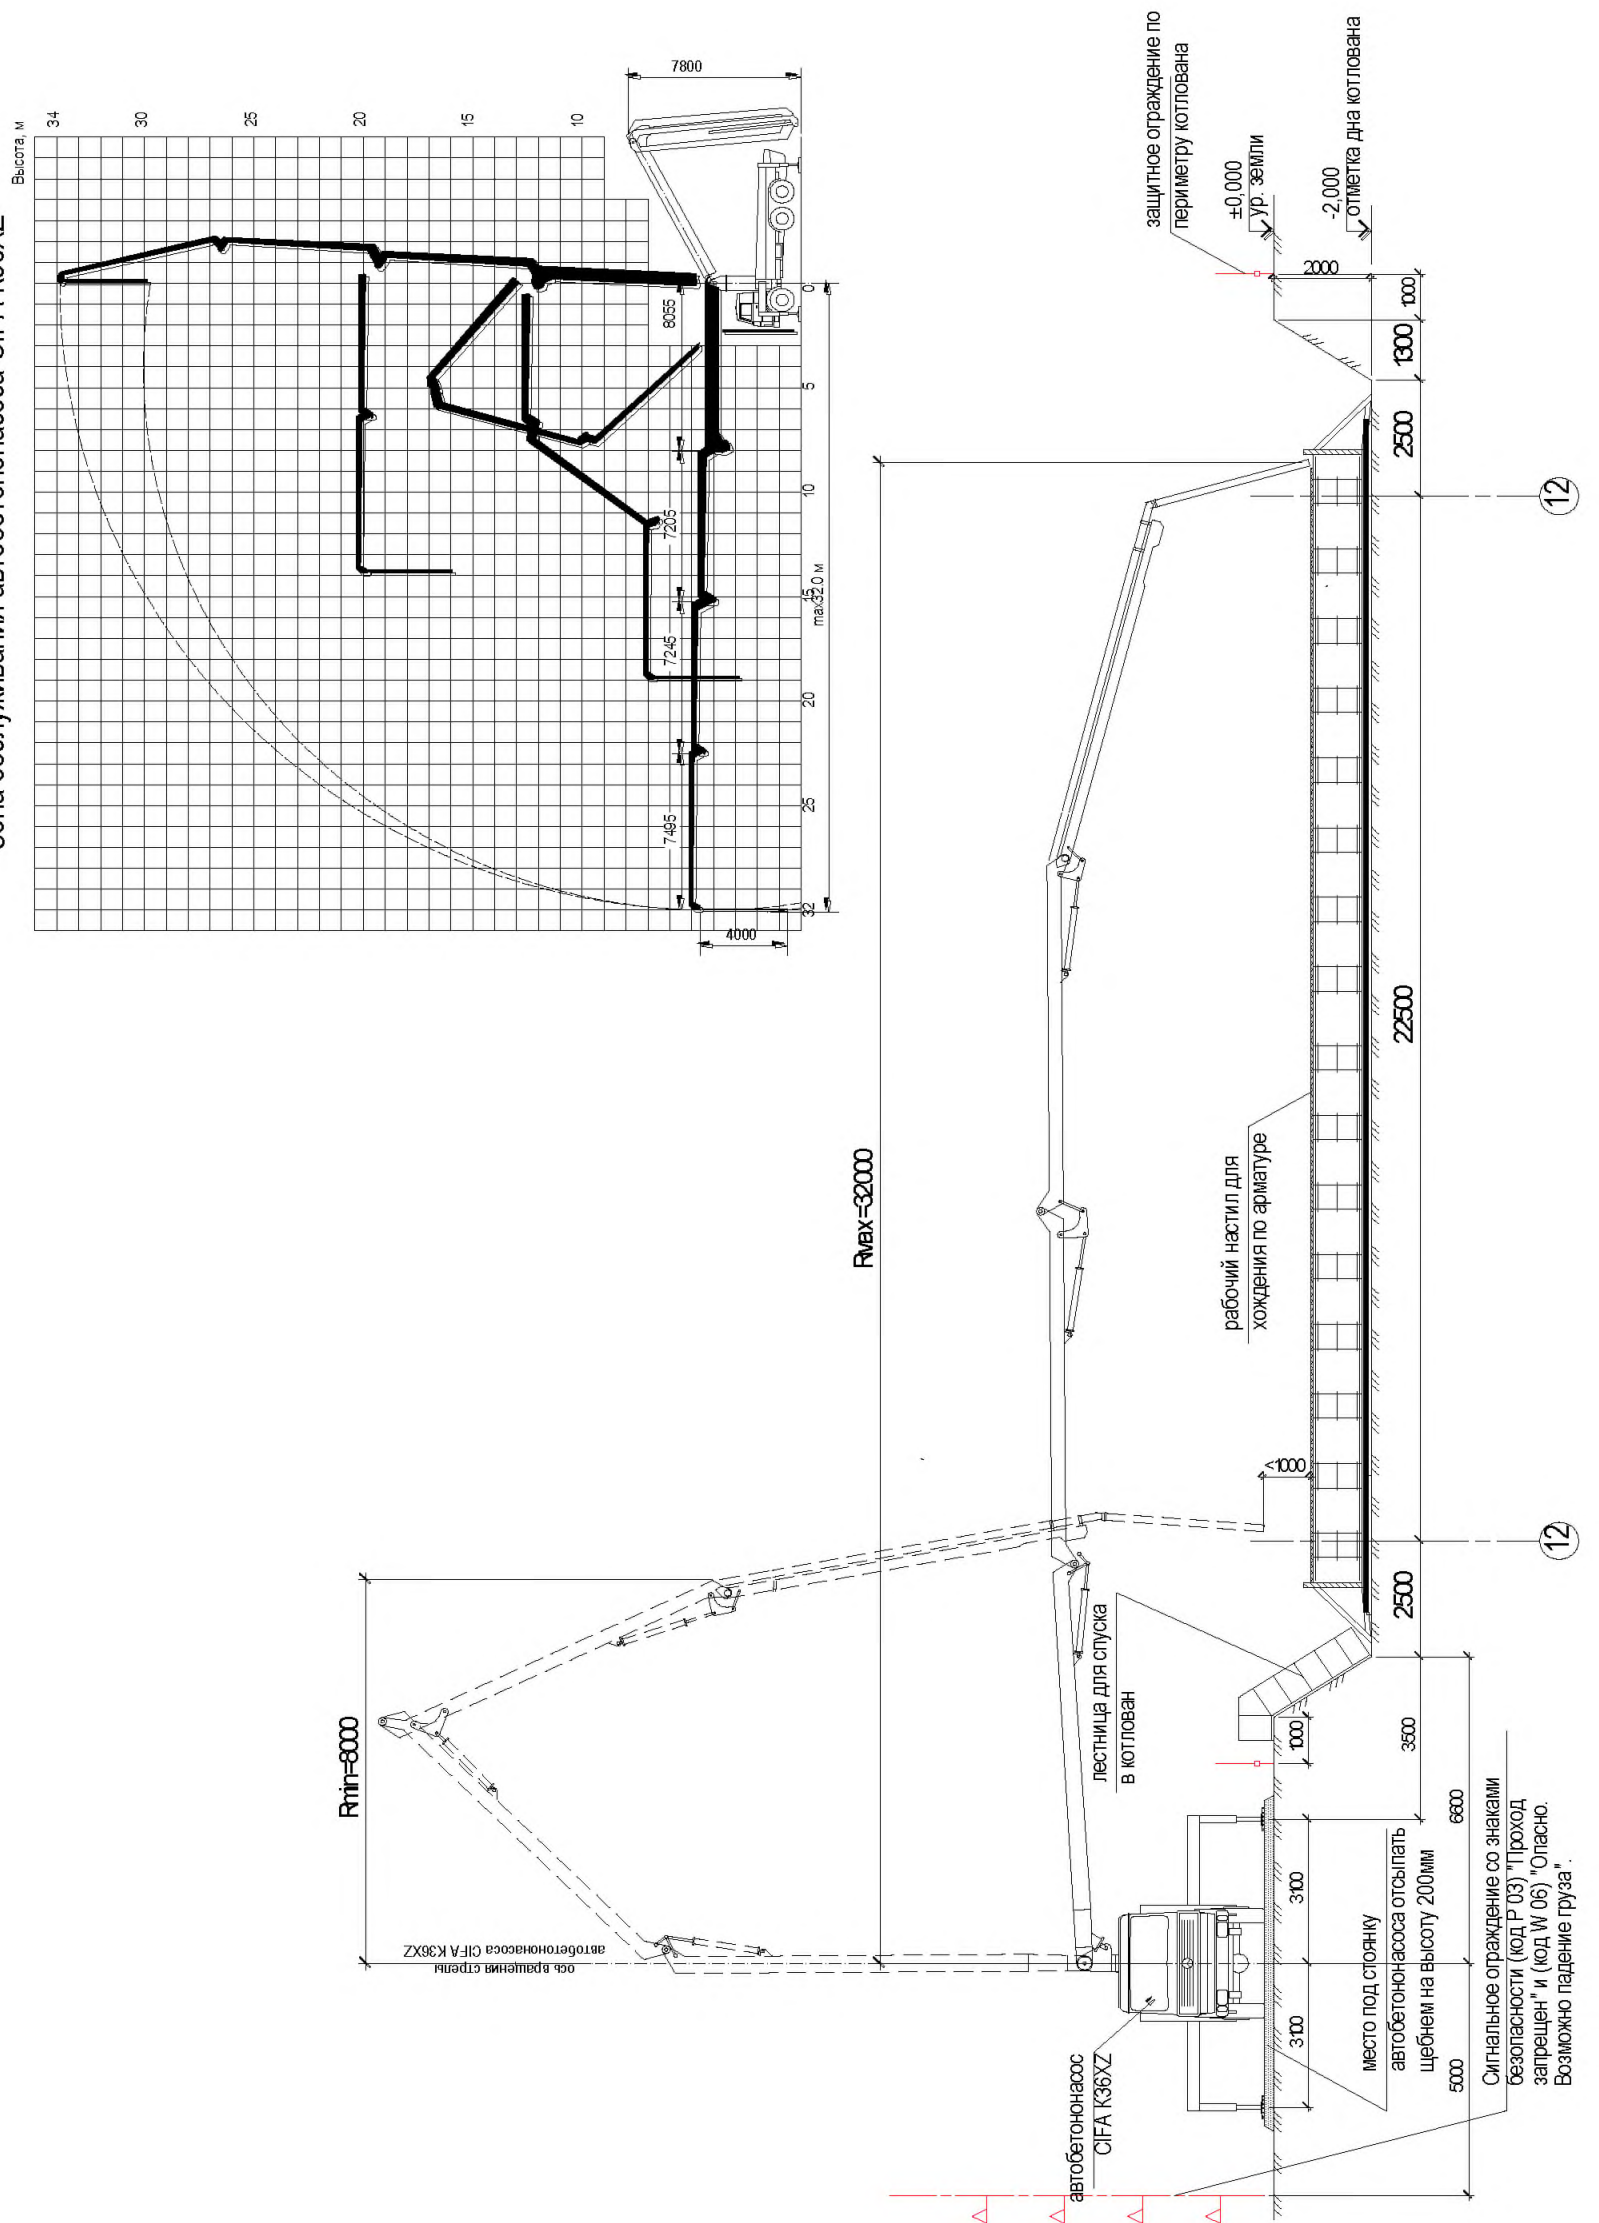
Разрез 1-1 к схеме производства работ по бетонированию фундаментной плиты
